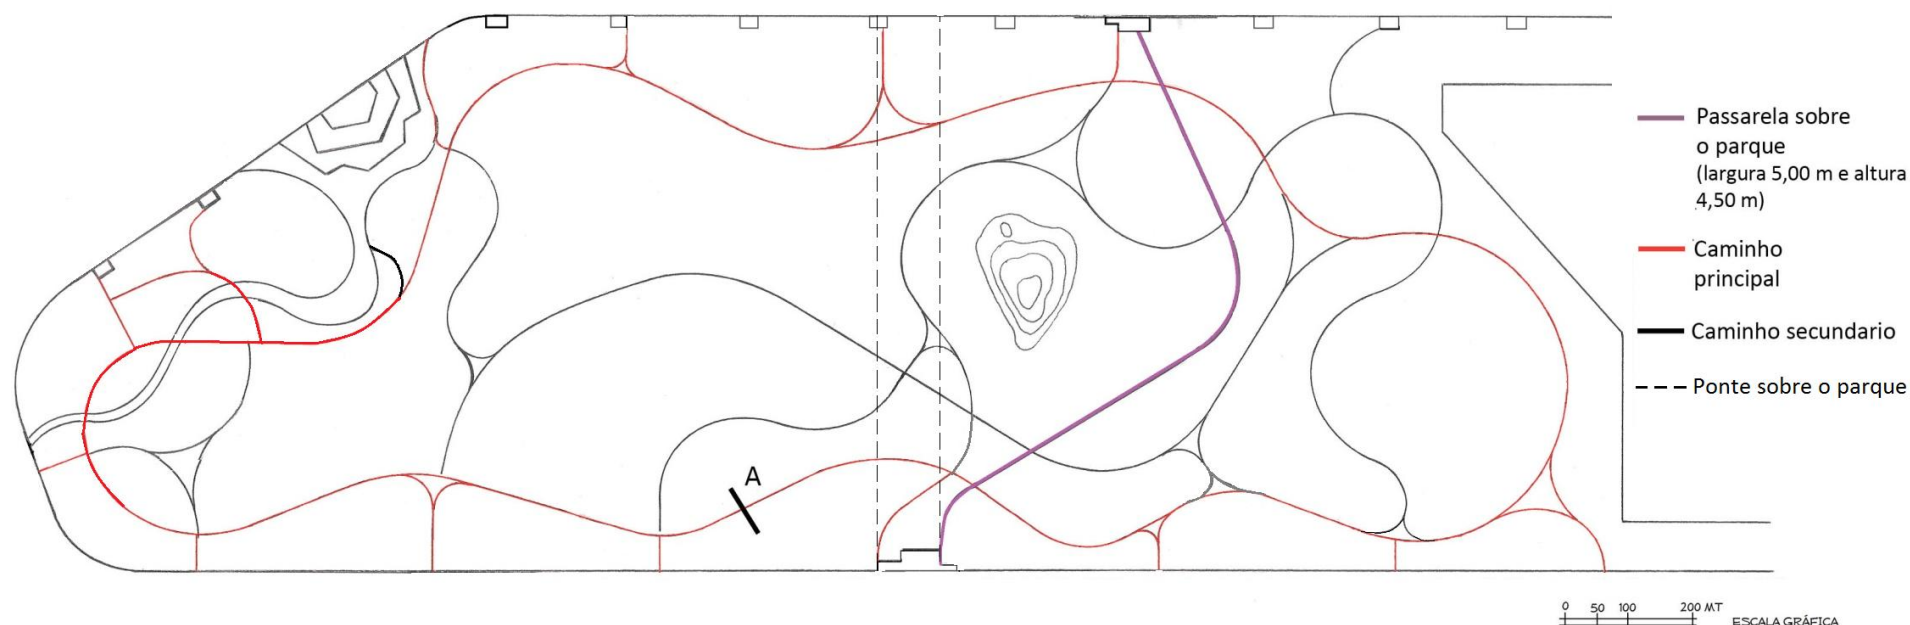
Planta Baixa do Parque: Circuito dos Caminhos Principal e Secundário
